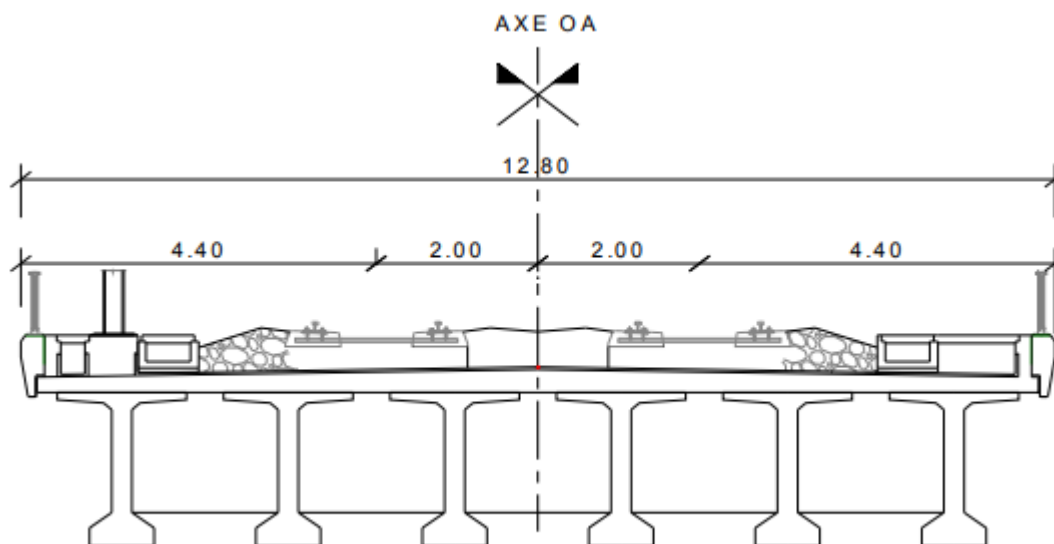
Coupe transversale type tablier poutres précontraintes (pont rail)
